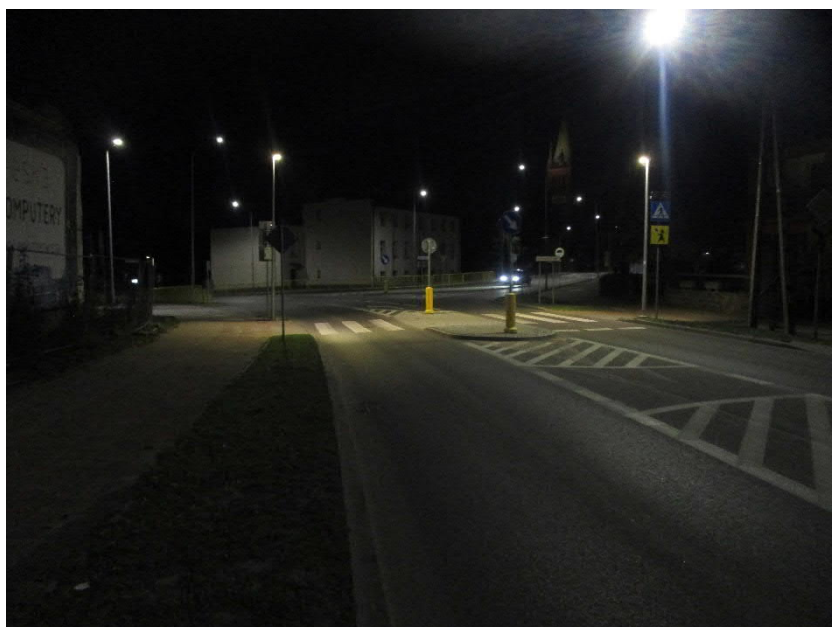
Wlot ul. Wybickiego (wschodni) – widok w kierunku skrzyżowania – nieprawidłowe warunki oświetlenia przejścia dla pieszych
